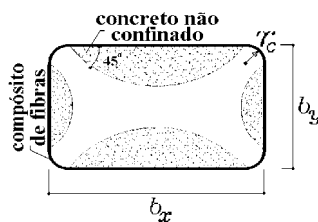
Área de Concreto Efetivamente Confinado em Seção Quadrada ou Retangular
